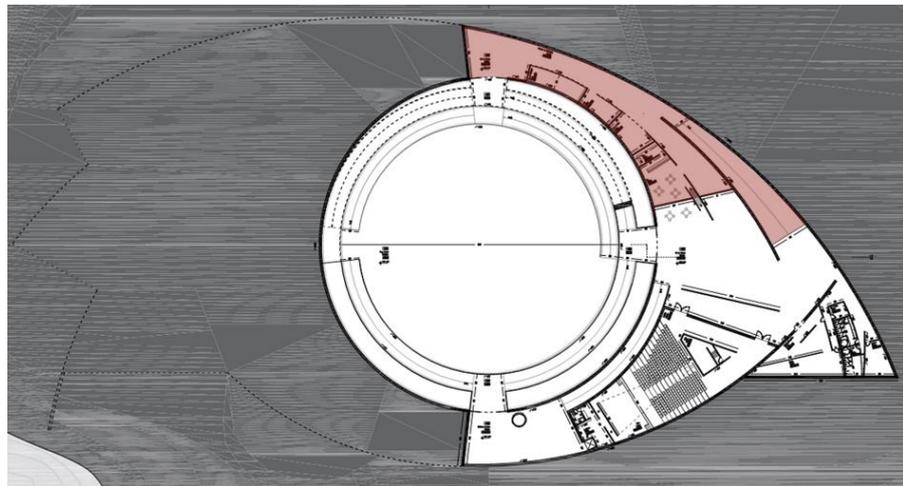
Continuação da planta do piso -3- zona lúdica.
